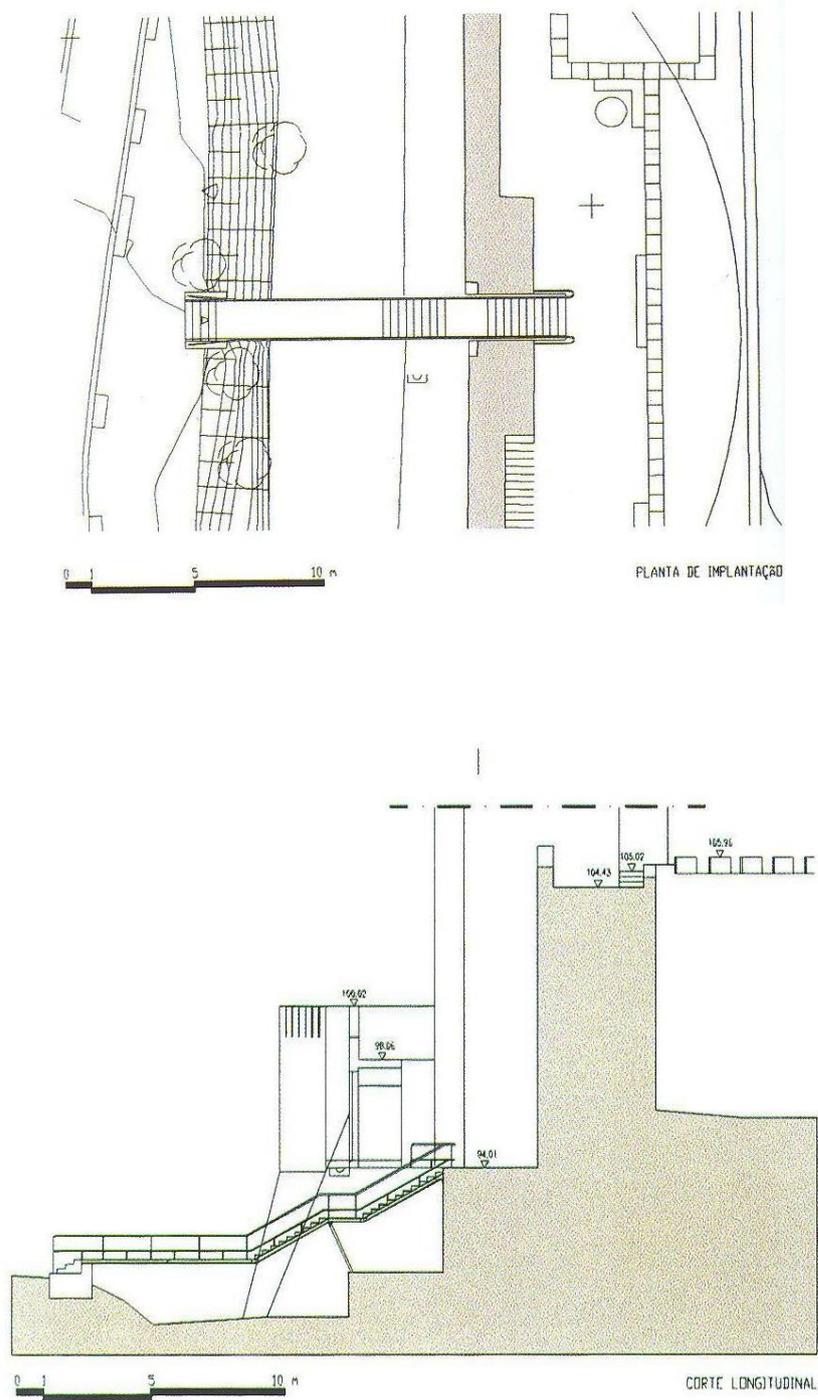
Planta de implantação (Architècti, 2000, p.41).
